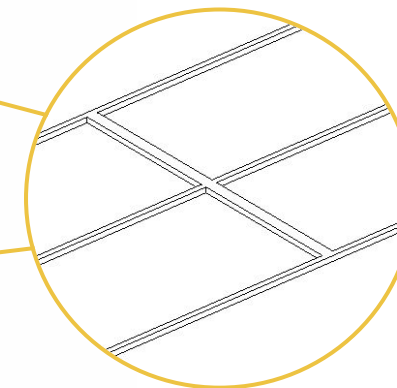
Materialidad estructural de elementos horizontales. Elaboración propia
